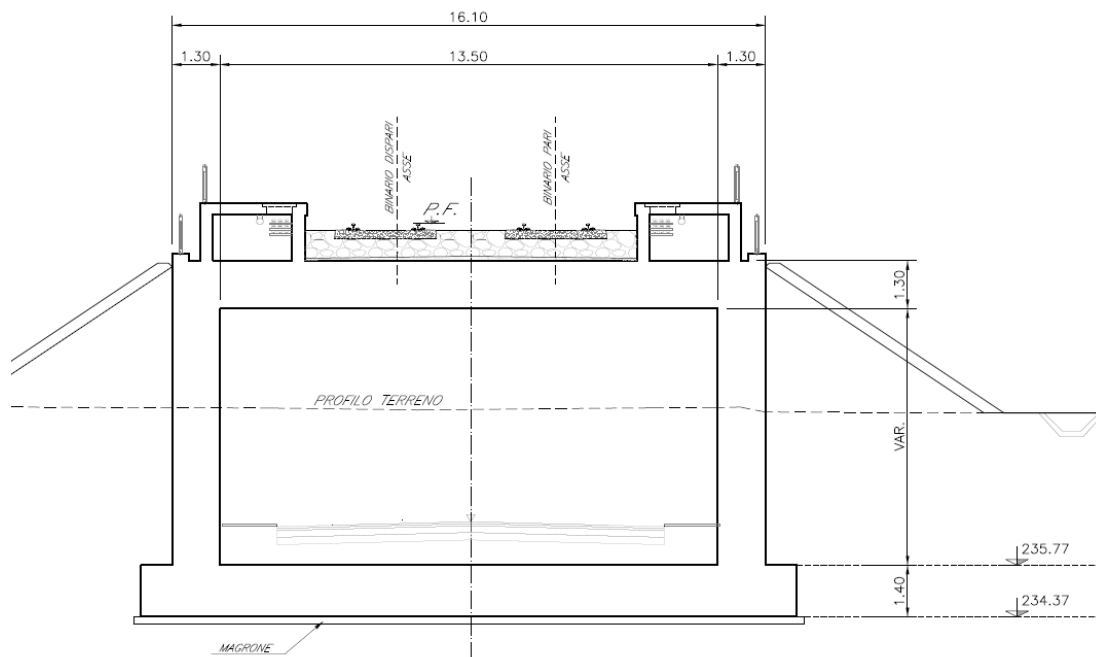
Sezione trasversale in asse ferroviario Sottovia scatolare SL01
